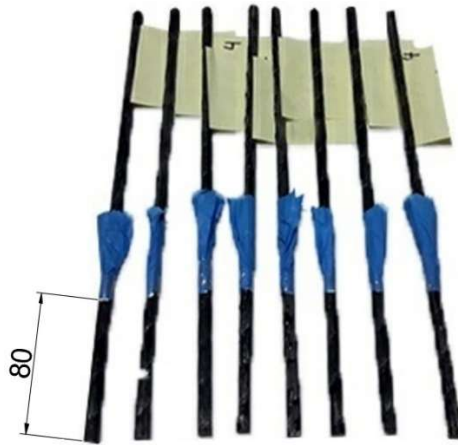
Varillas de fibra de vidrio adaptadas con zona de no adhesión. Cotas en mm.
